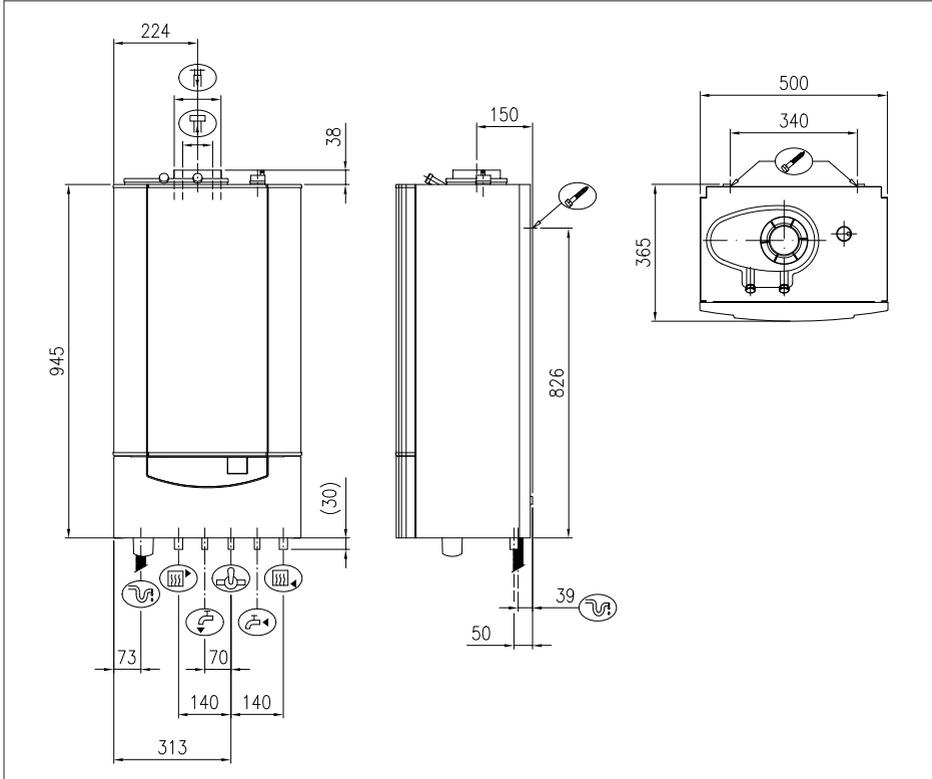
Dimensiones Remeha Quinta 28c y 35c
